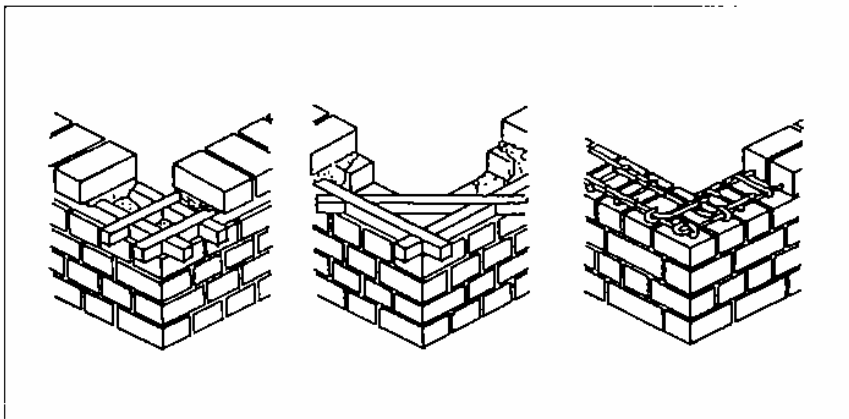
Chaînages en grillage noyé dans le mortier ou en béton armé.
